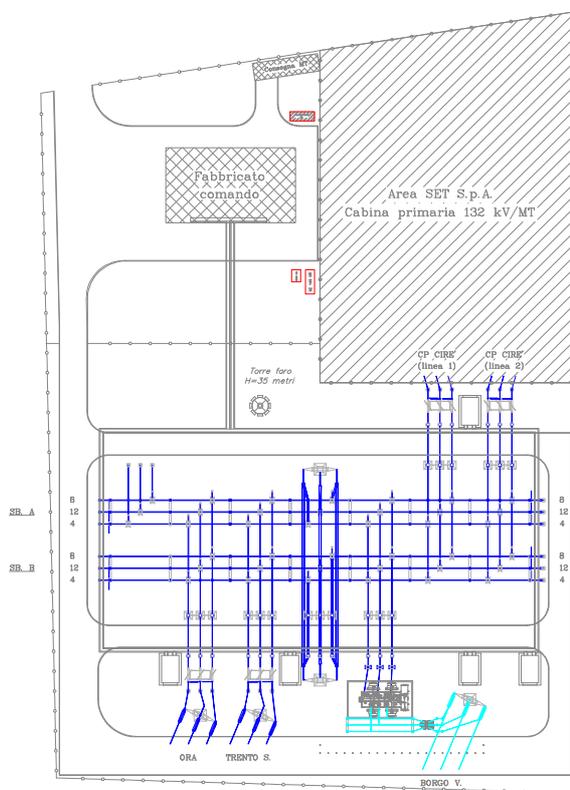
S/E. di Cirè – Planimetria impianto
